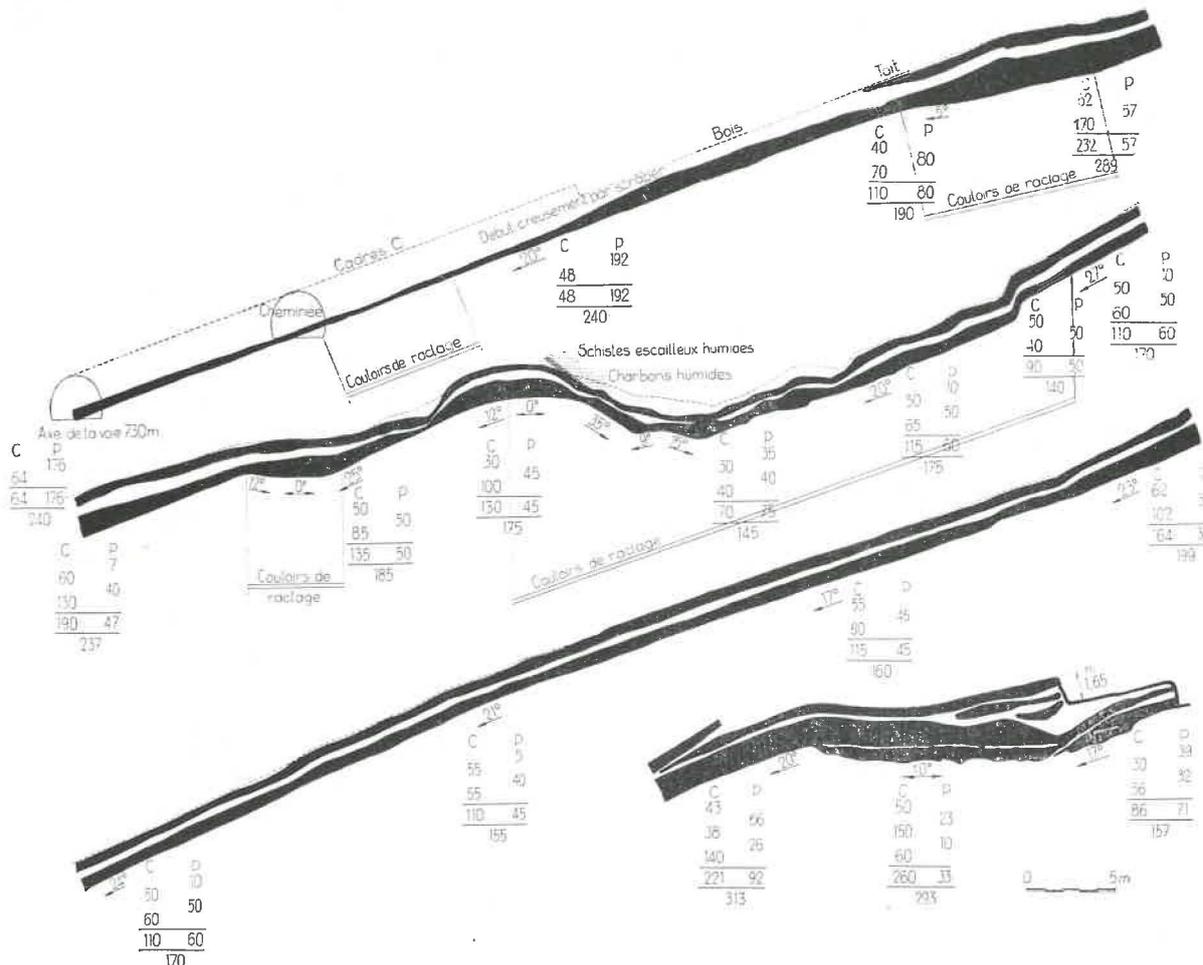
Siège n° 10. Profil du montage dans Follemprise. Etage 730 m - 1400 m.
